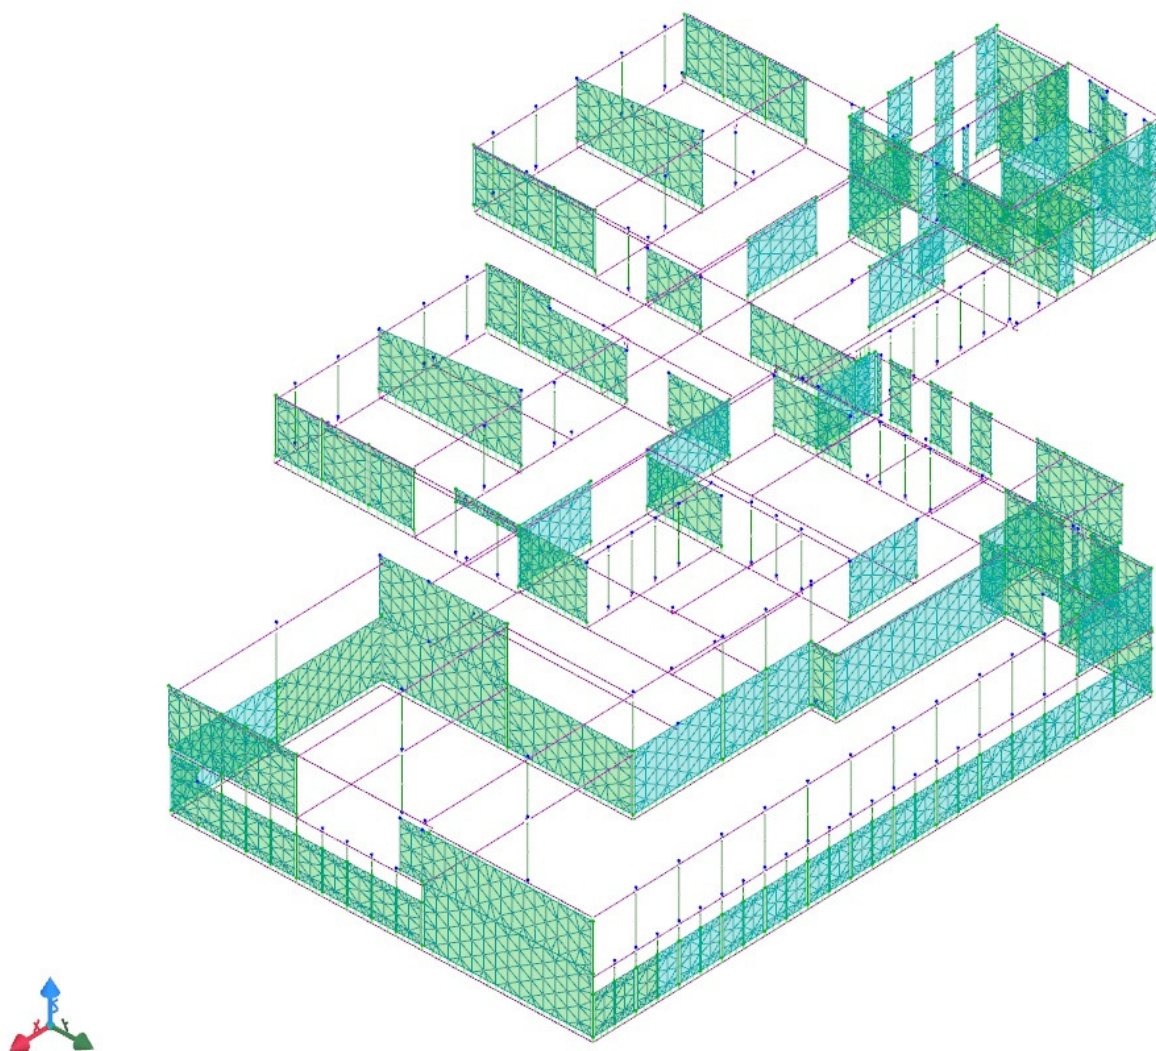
Vista strutturale della modellazione ad elementi finiti dell'edificio da est.
